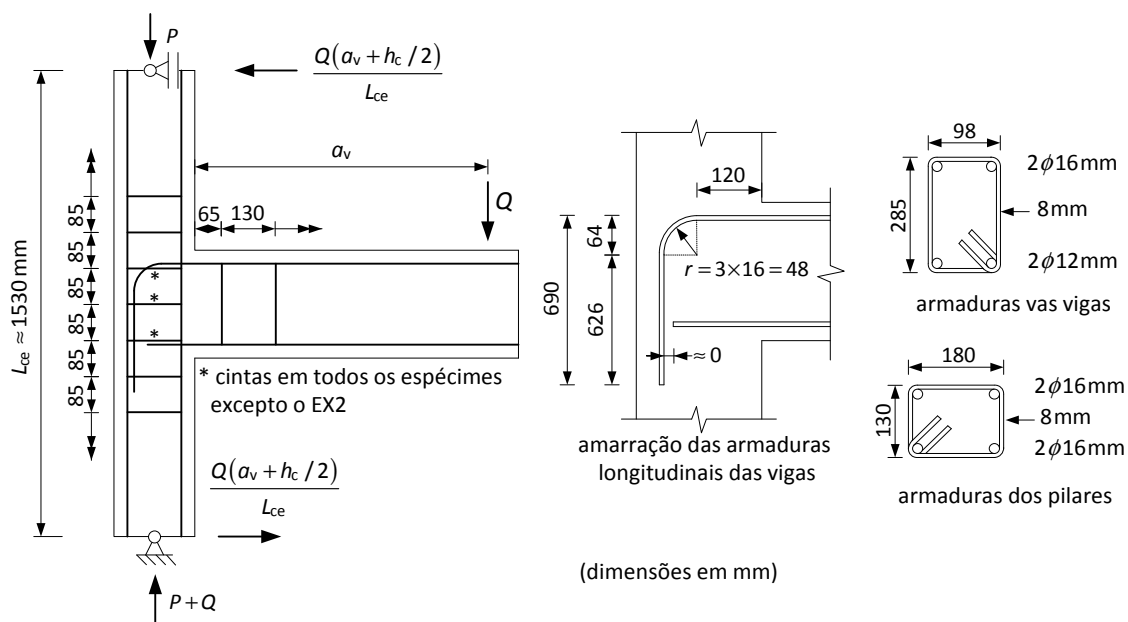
Ligações viga-pilar de betão armado de extremidade ensaiadas por Sarsam [1983].
